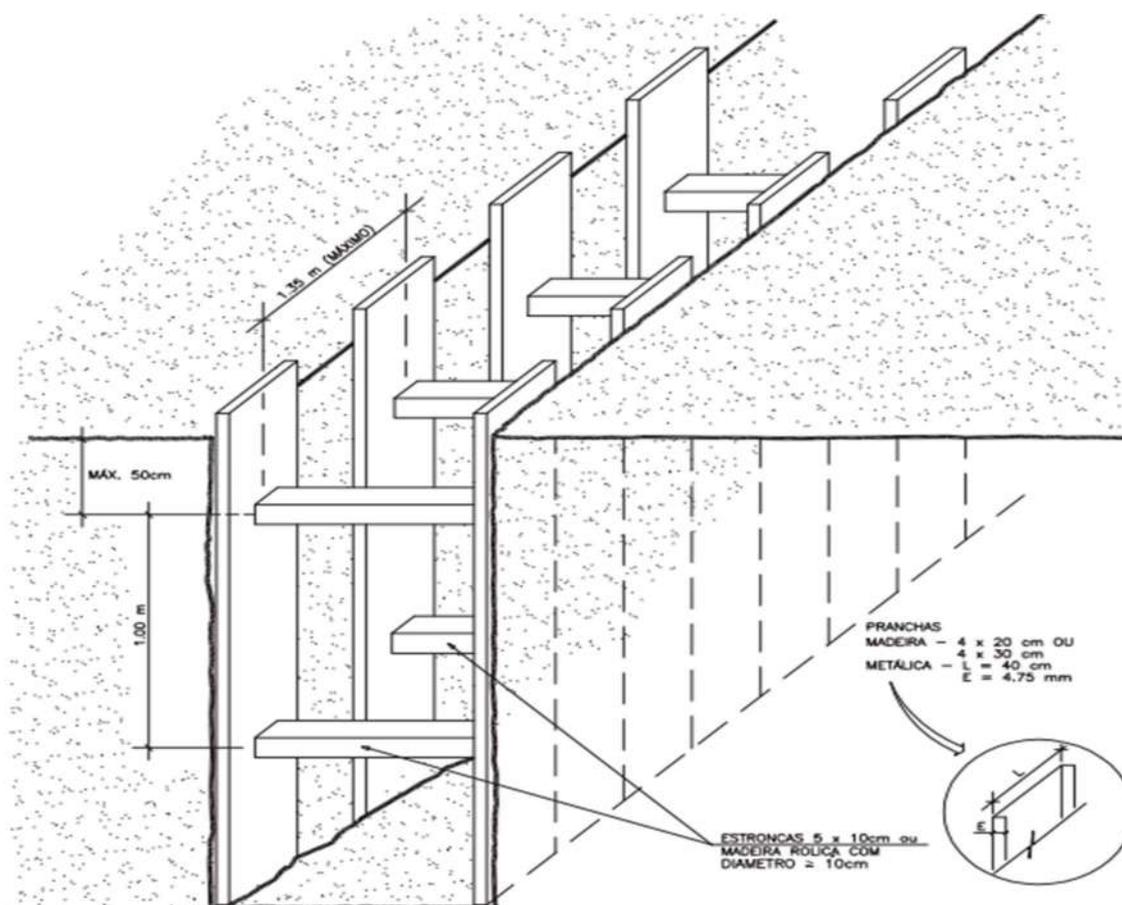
Detalhe de escoramento tipo Pontalete Metálico
